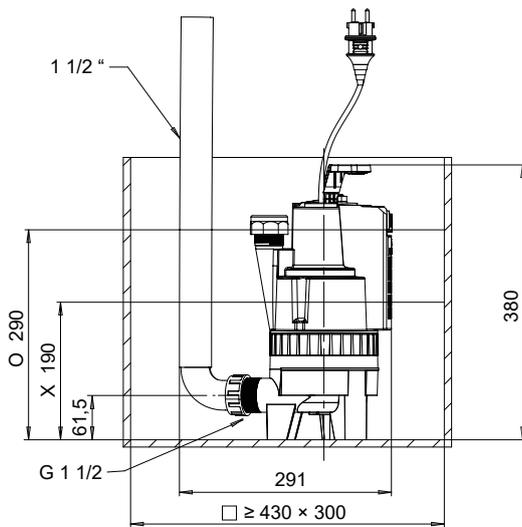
Dimensiones AmaDrainer 354 [mm]
